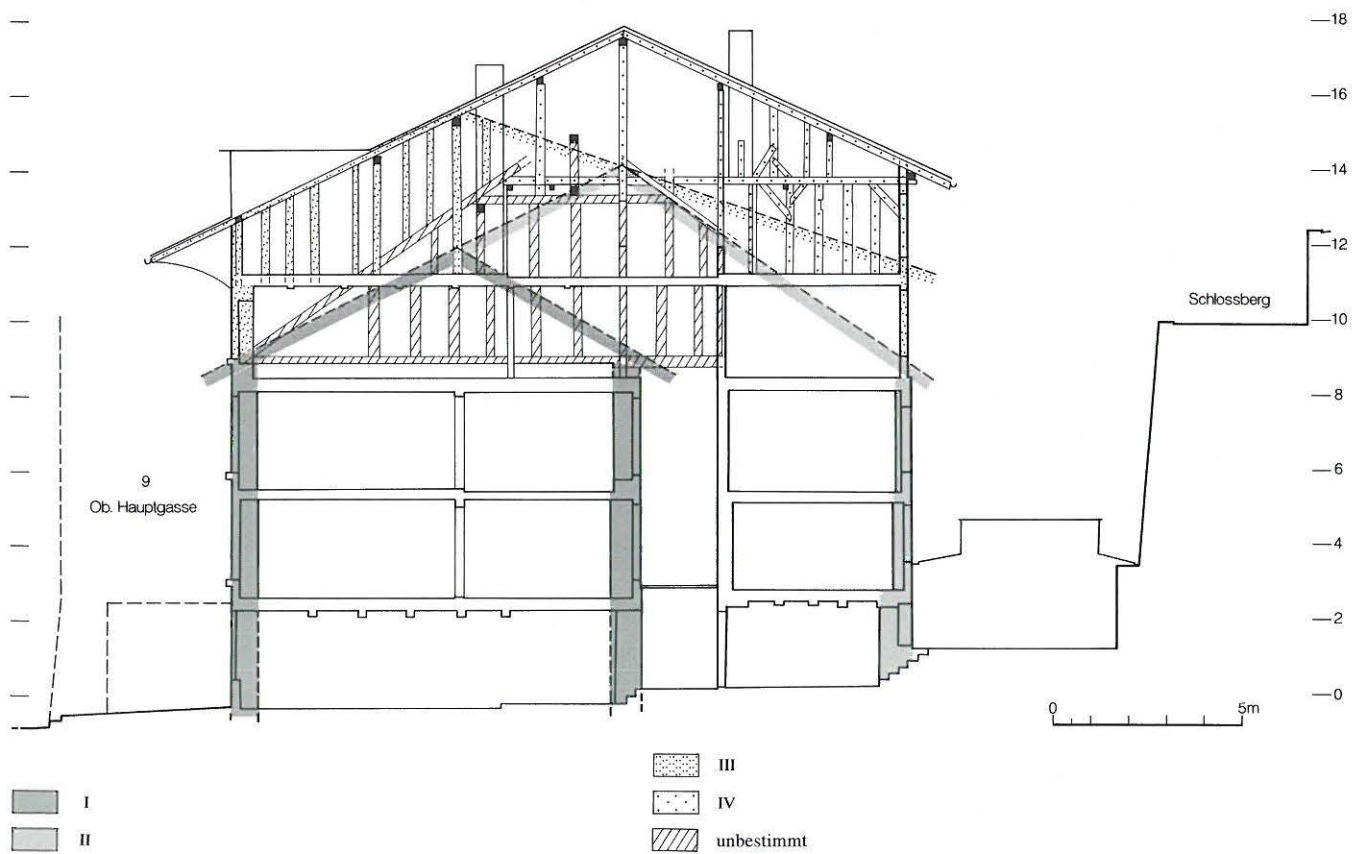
Thun, Obere Hauptgasse 9/11. Westliche Brandmauer Nr. 9 nach Westen. M. 1:200.
